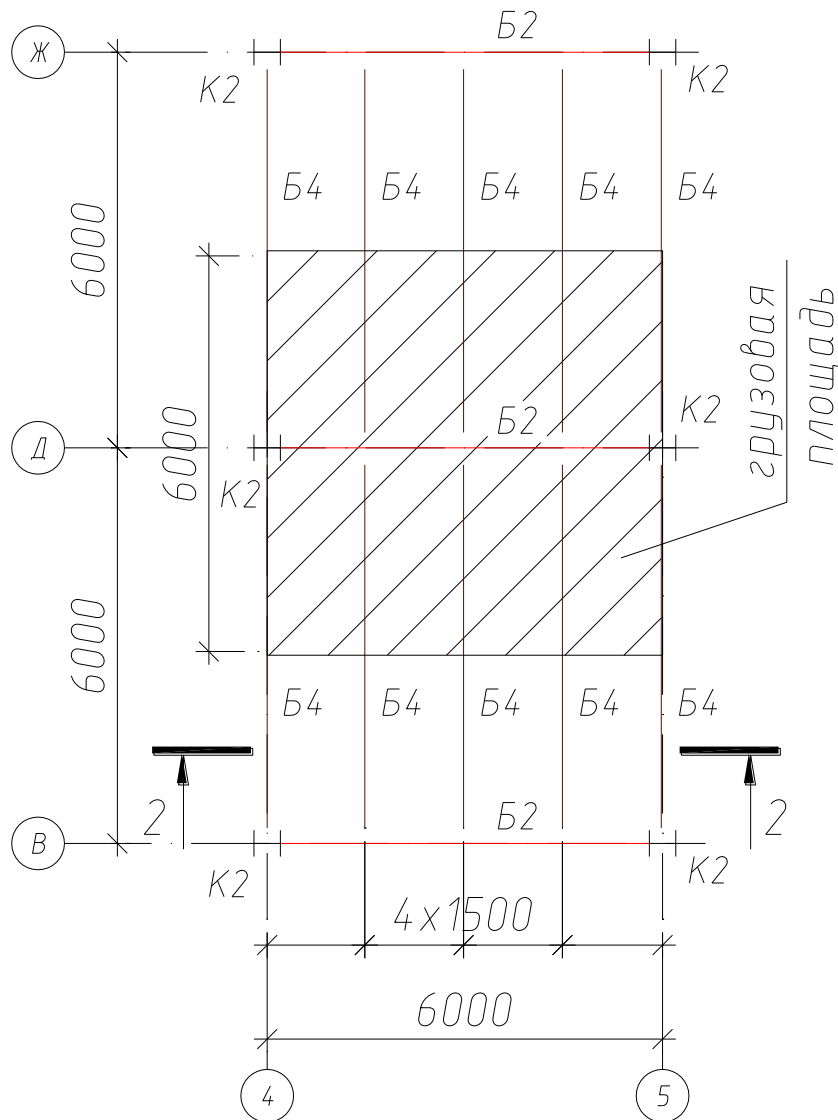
Определение грузовой площади главной балки Б2
